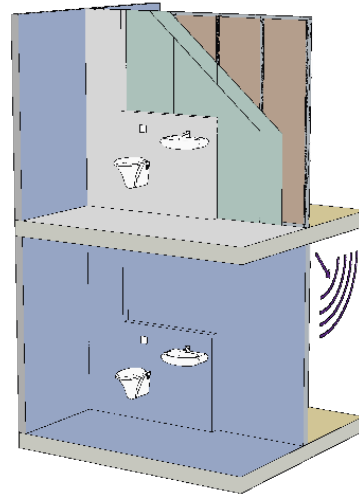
Teilhohe Vorwandinstallation in Trockenbauweise mit raumhohem Installationsschacht vor einer Metallständerwand W112.de [2]
